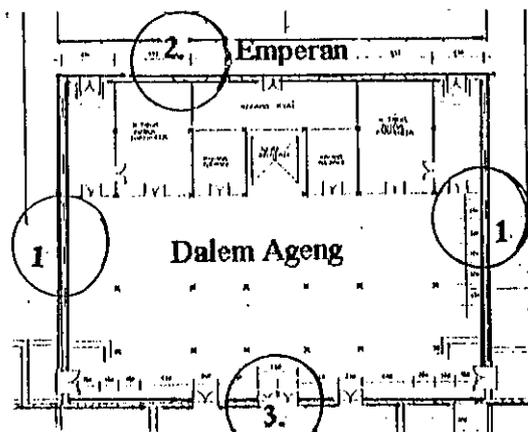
, Bentuk Denah Dalem Ageng (Denah rumah Jawa).
